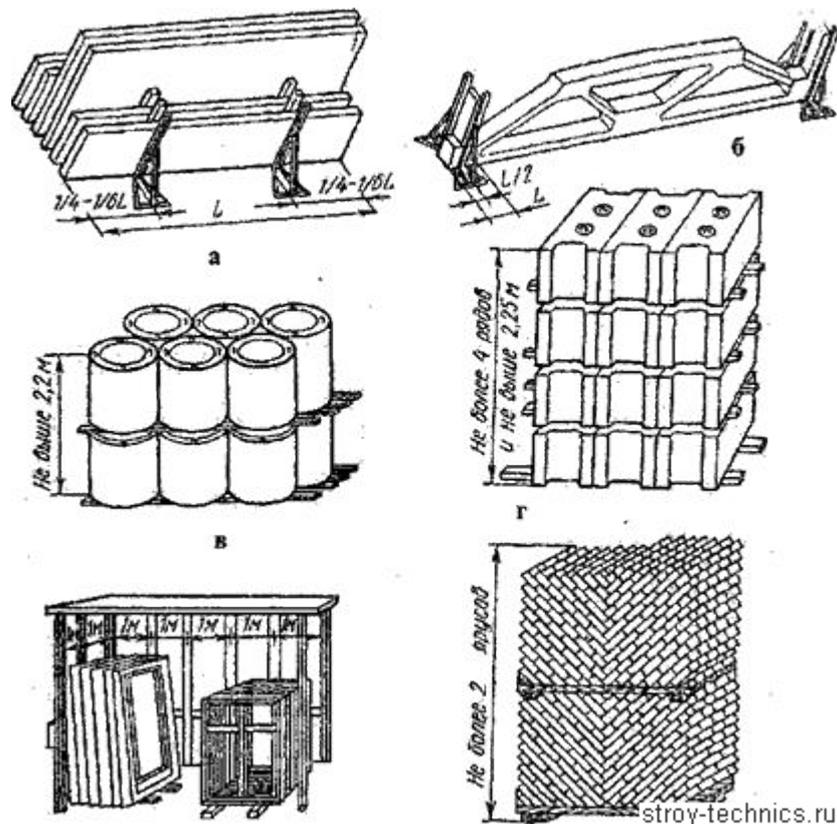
Укладка грузов в вертикальном и наклонном положениях: а – панели; б – фермы; в – кольца; г – блоки; д – оконные и дверные коробки; е – кирпич на поддонах
